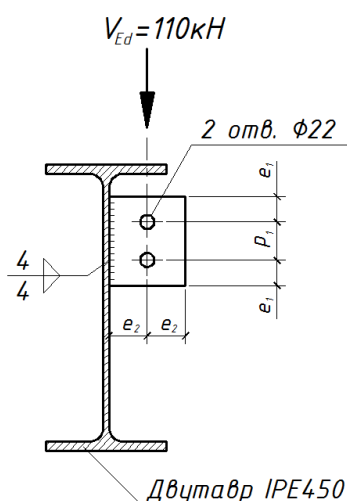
Сварное соединение вертикальной накладки к двутавру IPE 450
